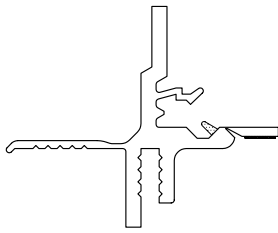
Bauanschluss mit Montageleiste 54 33 30
